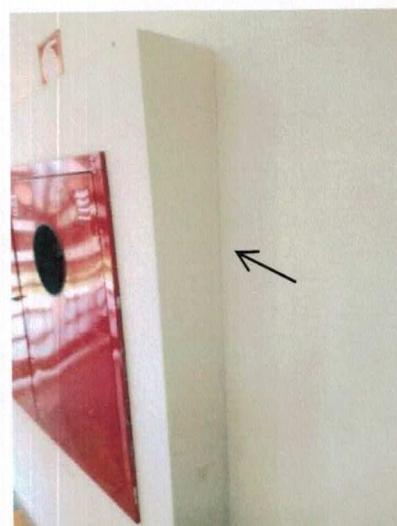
Foto da Parede: Fissura na junção da parede do abrigo de hidrante - RECEPÇÃO
